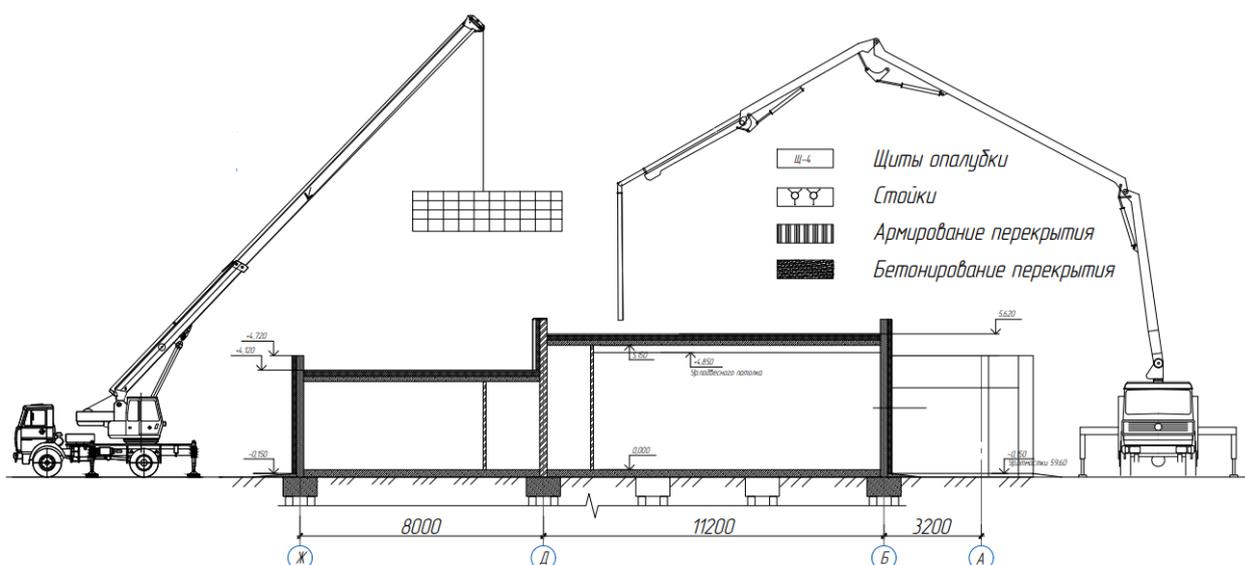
Схема укладки бетонной смеси и подачи пакета с арматурой
